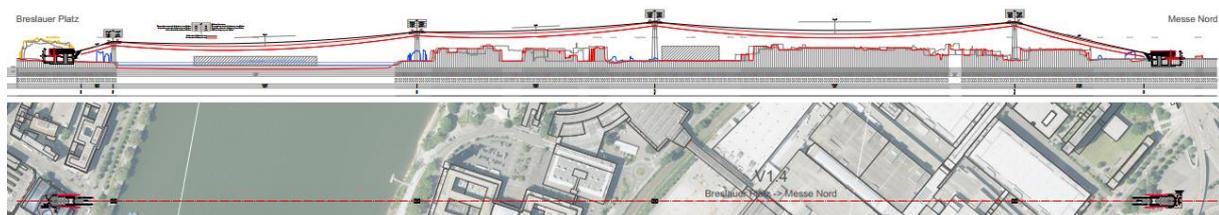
Längenschnitt, Lageplan Variante V1.4
